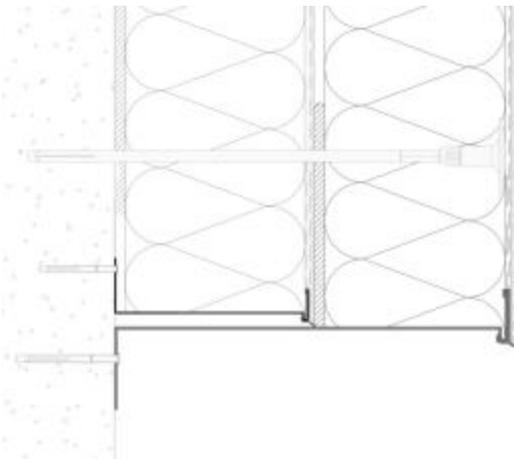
Traitement des points singuliers avec chevillage Baumit StarTrack – cas de la pose de bandes filantes
